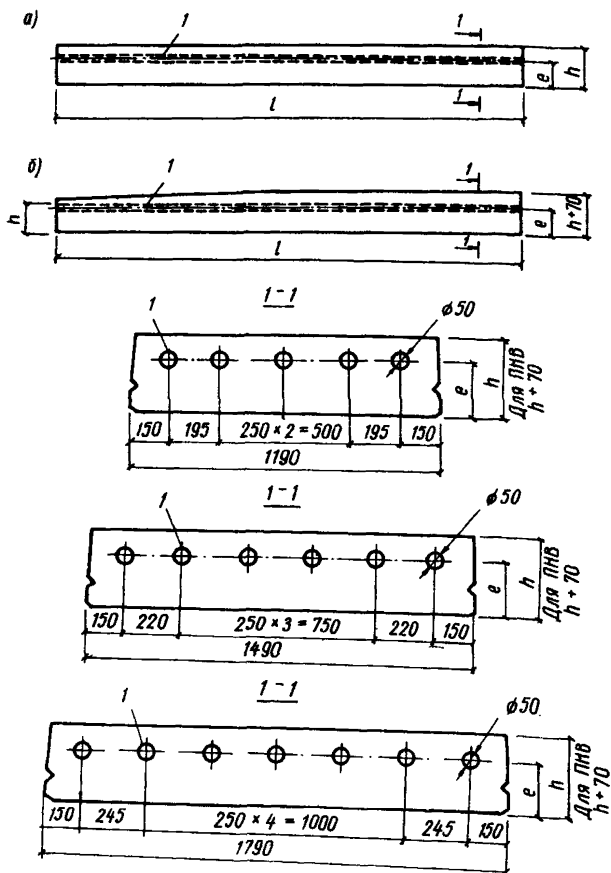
Типы вентилируемых ячеистобетонных панелей покрытий для жилых и общественных зданий
